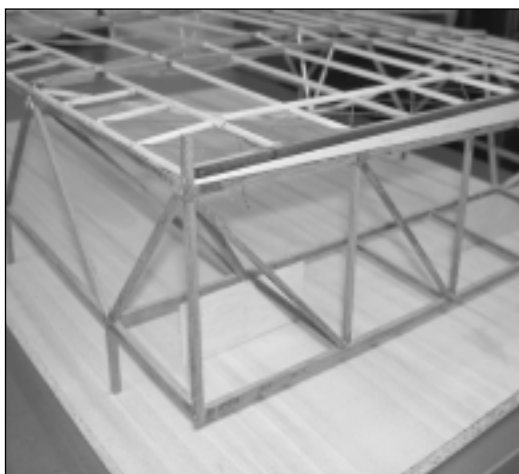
Detall exterior maqueta. | *Detalle exterior maqueta.
